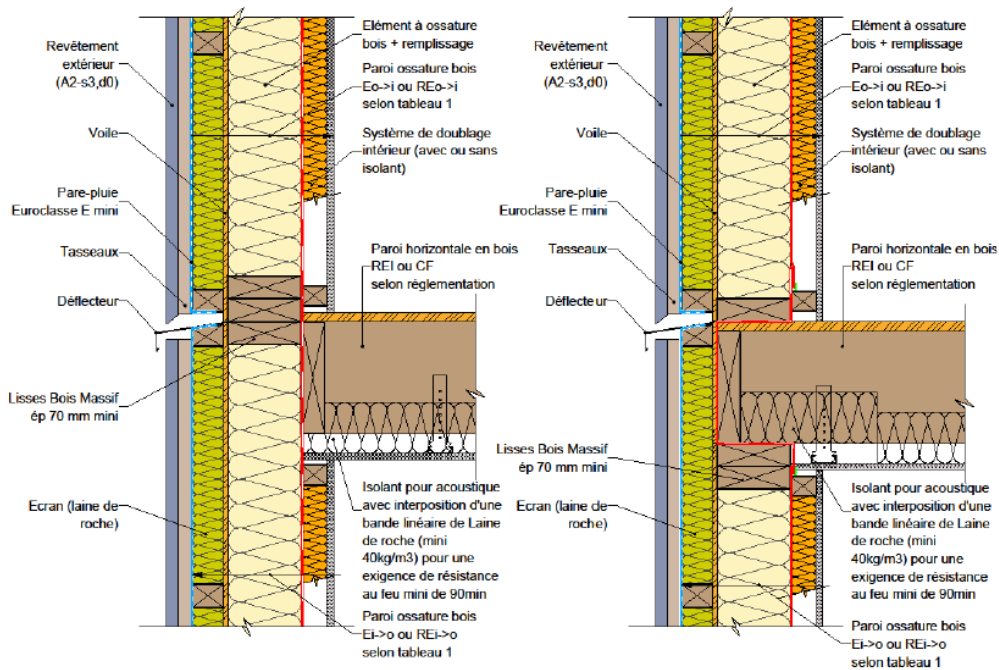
Façade/mur en ossature bois & plancher en ossature bois pouvant être mis en place pour des bâtiments d'habitation neufs de 4ème famille (source : CSTB)
